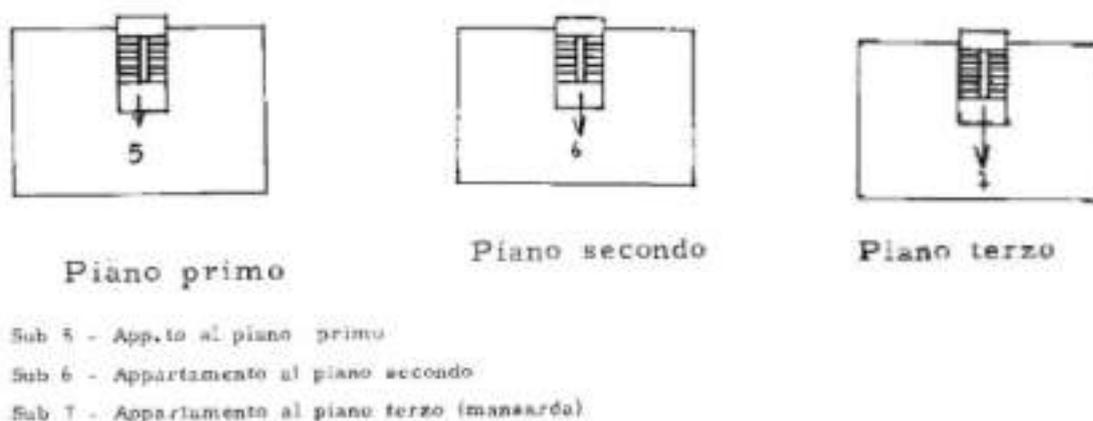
Stralcio elaborato planimetrico piano primo, piano secondo e piano terzo del fabbricato ed elenco subalterni.
